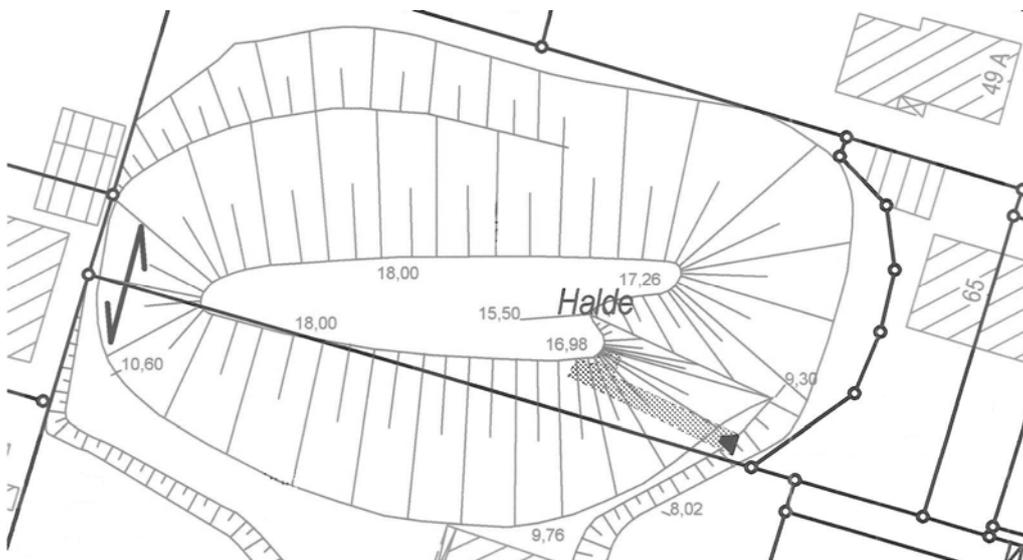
Lageplan Luftschutzstollen TONHALDE
